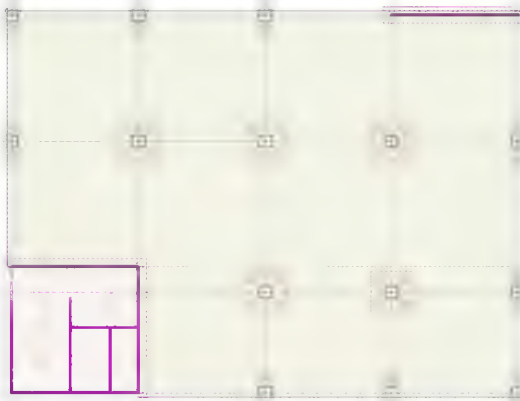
Конструктивна схема будівлі Рис. 3.2. Розрахункова модель будівлі
